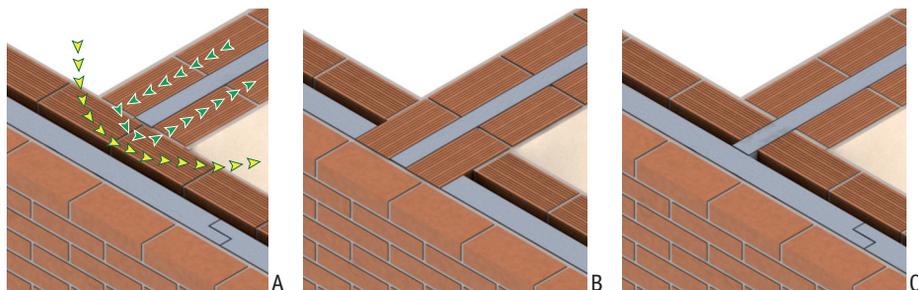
Alcune configurazioni del collegamento tra parete divisoria interna e parete di facciata a doppio strato in elementi di laterizio.
